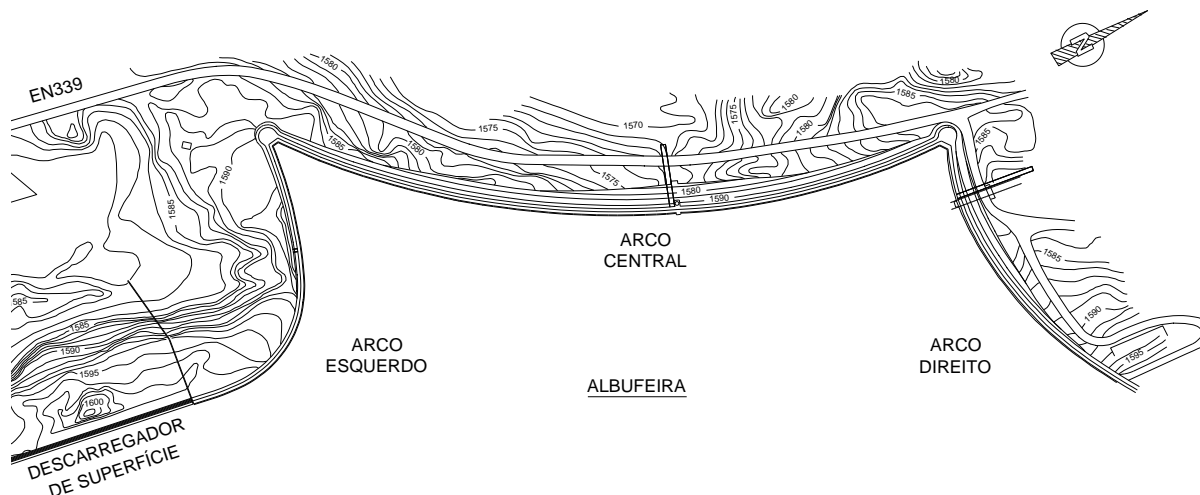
Planta geral da barragem da Lagoa Comprida
